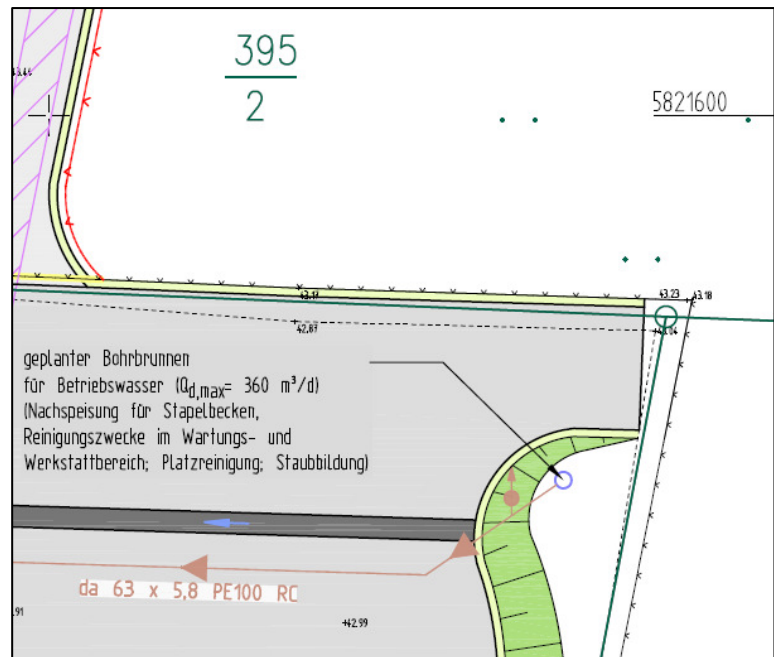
Lage des geplanten RC-Platzes und Brunnens - Ortsplan Wathlingen
